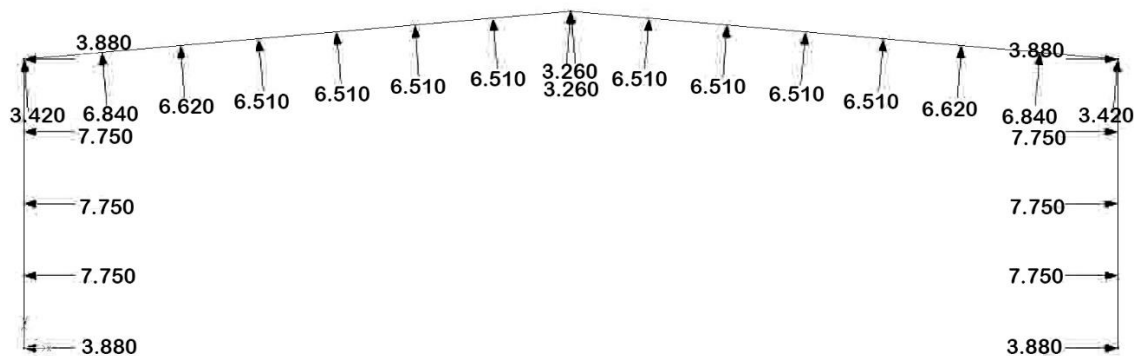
Esquema das cargas aplicadas no pórtico devido ao vento longitudinal.
